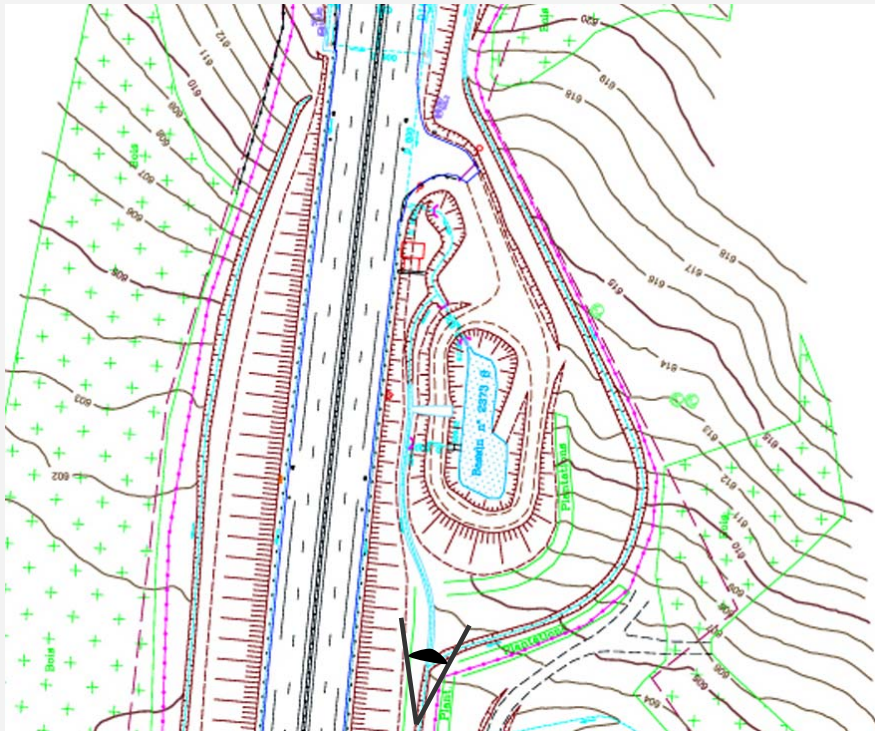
plan masse technique d'un bassin d'assainissement avant traitement paysager sur l' A89 (ASF)
